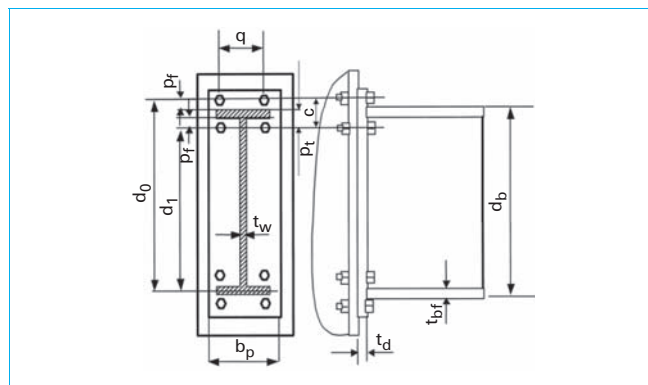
Assemblage par platines d'extrémité non raidies soudées à la poutre et boulonnées à l'âme du poteau par 4 rangées de boulons (d'après la norme FEMA 350)
